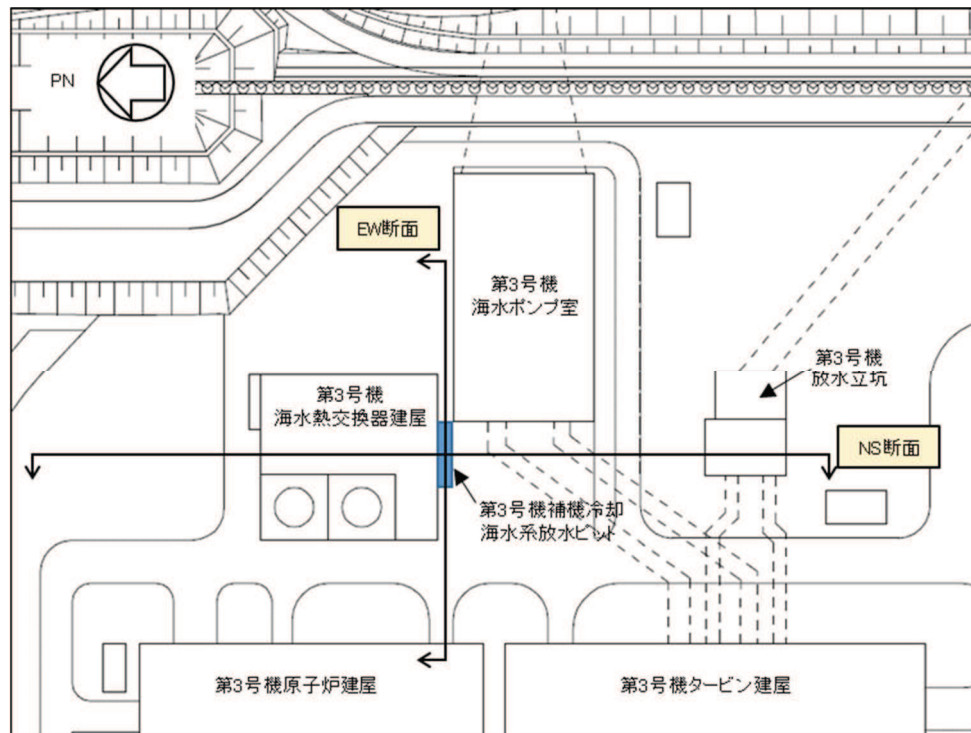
第 3 号機補機冷却海水系放水ピット平面配置図
